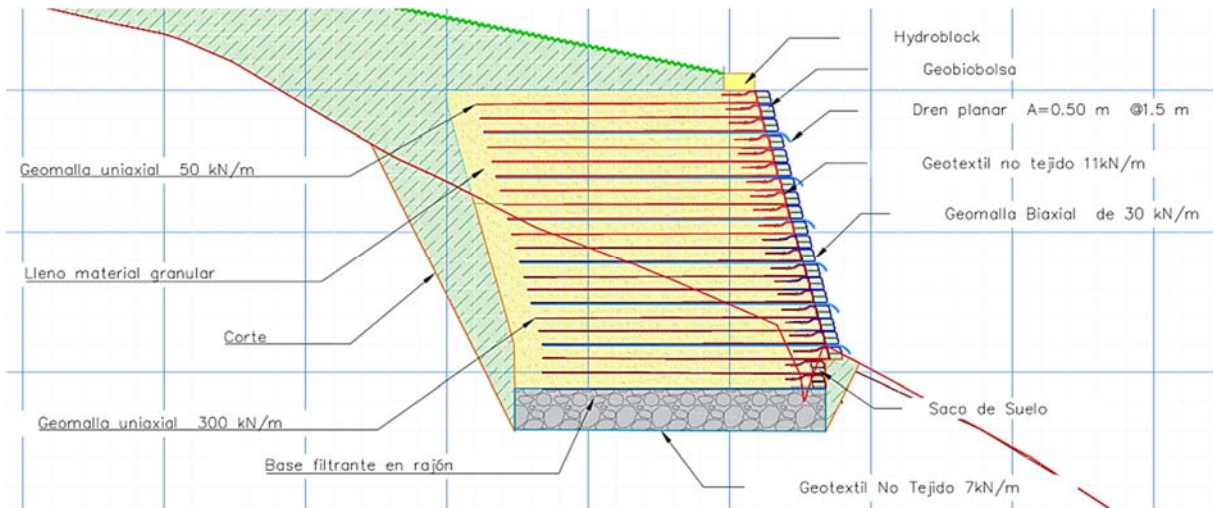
Detalle del muro en tierra armada propuesto.
